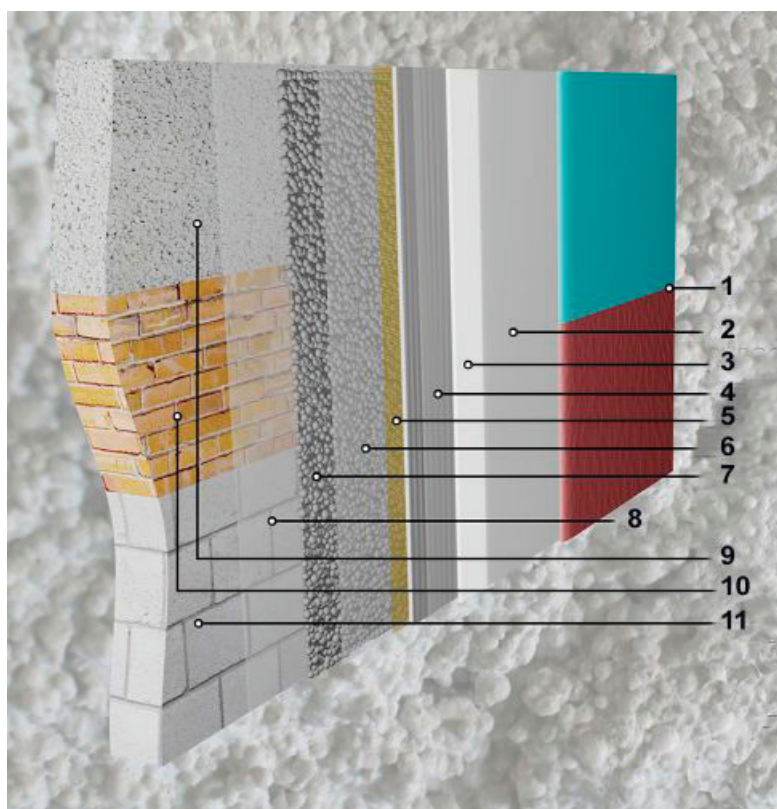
Последовательность слоев при отделке фасада теплой штукатуркой: 1. Декоративный слой 2. Грунтовка 3. Шпаклевка БИРСС 374 4. Грунтовка 5. Клей БИРСС Термопор с сеткой 6. Грунтовка 7. Теплая штукатурка БИРСС Термопор 8. Грунтовка 9. Бетонное основание 10. Кирпичное основание 11. Блочное основание
